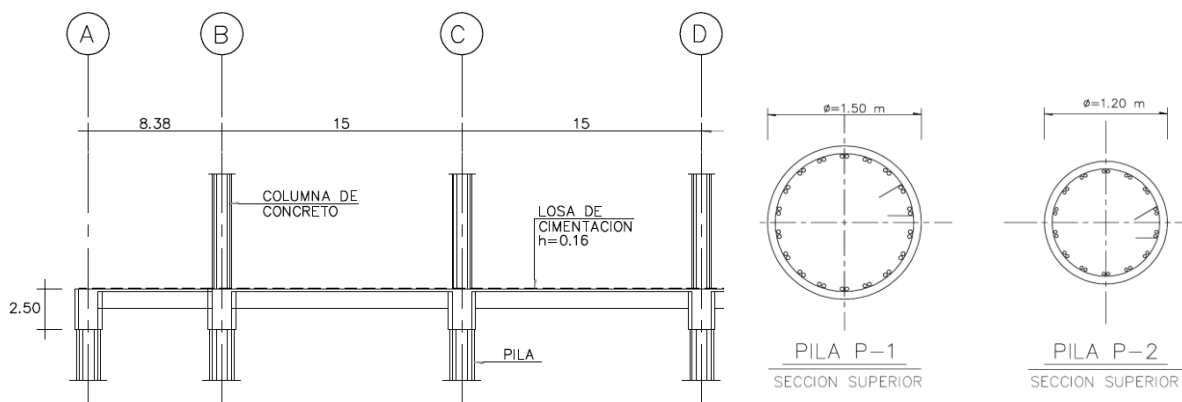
4 Corte esquemático de cimentación y tipos de pila (ASA, 2005)
